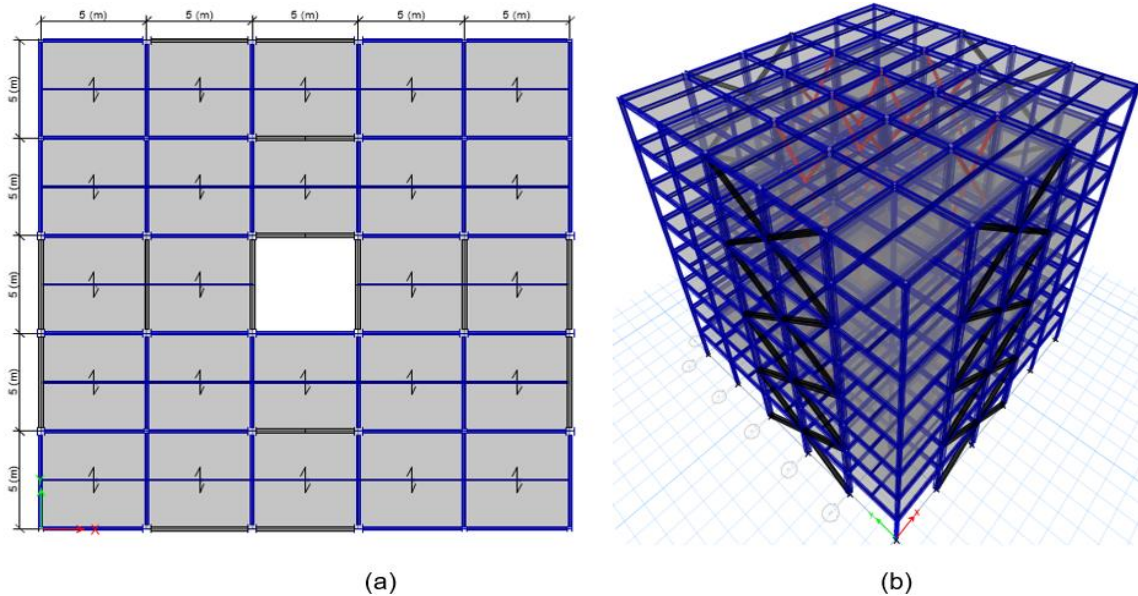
24: (a) Vista en planta y (b) Vista en 3D. Estructuras de 8 pisos.
